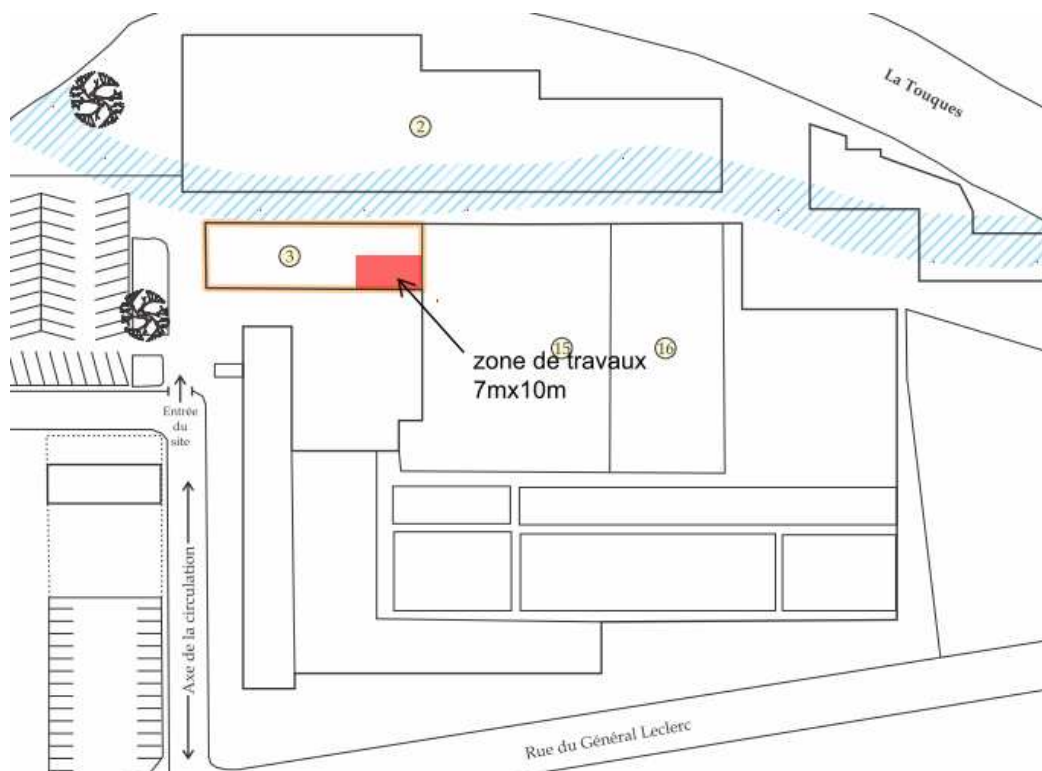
localisation de la zone de travaux sur l'ancien site Knorr Bremse
